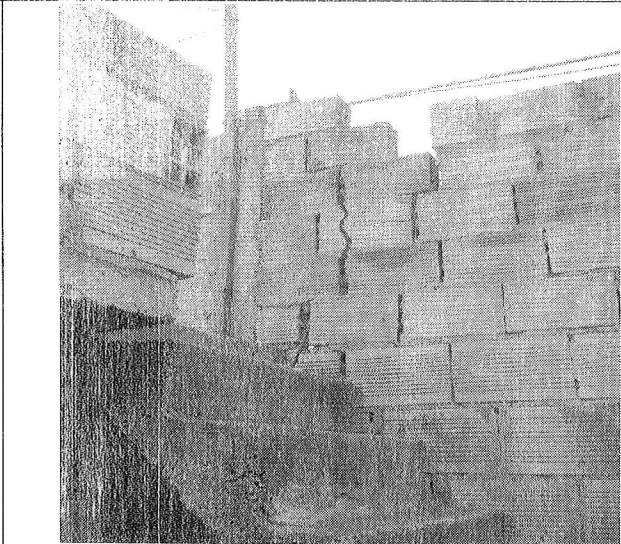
Predio Manzana 4 Lote 2. Detalle de los agrietamientos dentro en los muros de la vivienda
